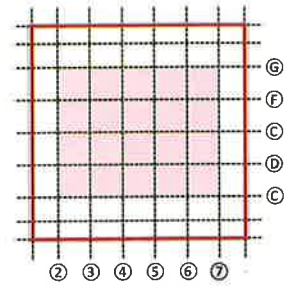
Exemplarischer Grundriss inklusive Deckenausschnitt des Atriums
